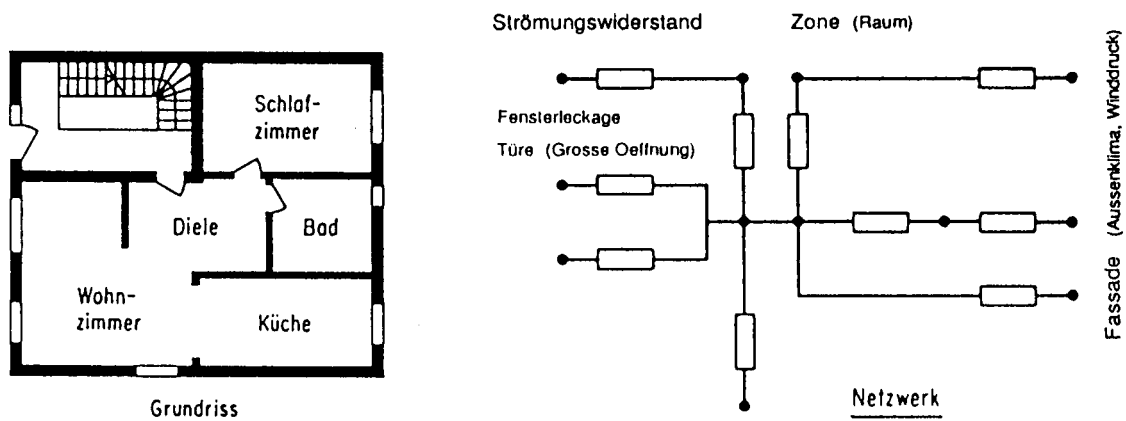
Modellierung eines Gebäudes mit Zonen und Strömungsdurchlässen
